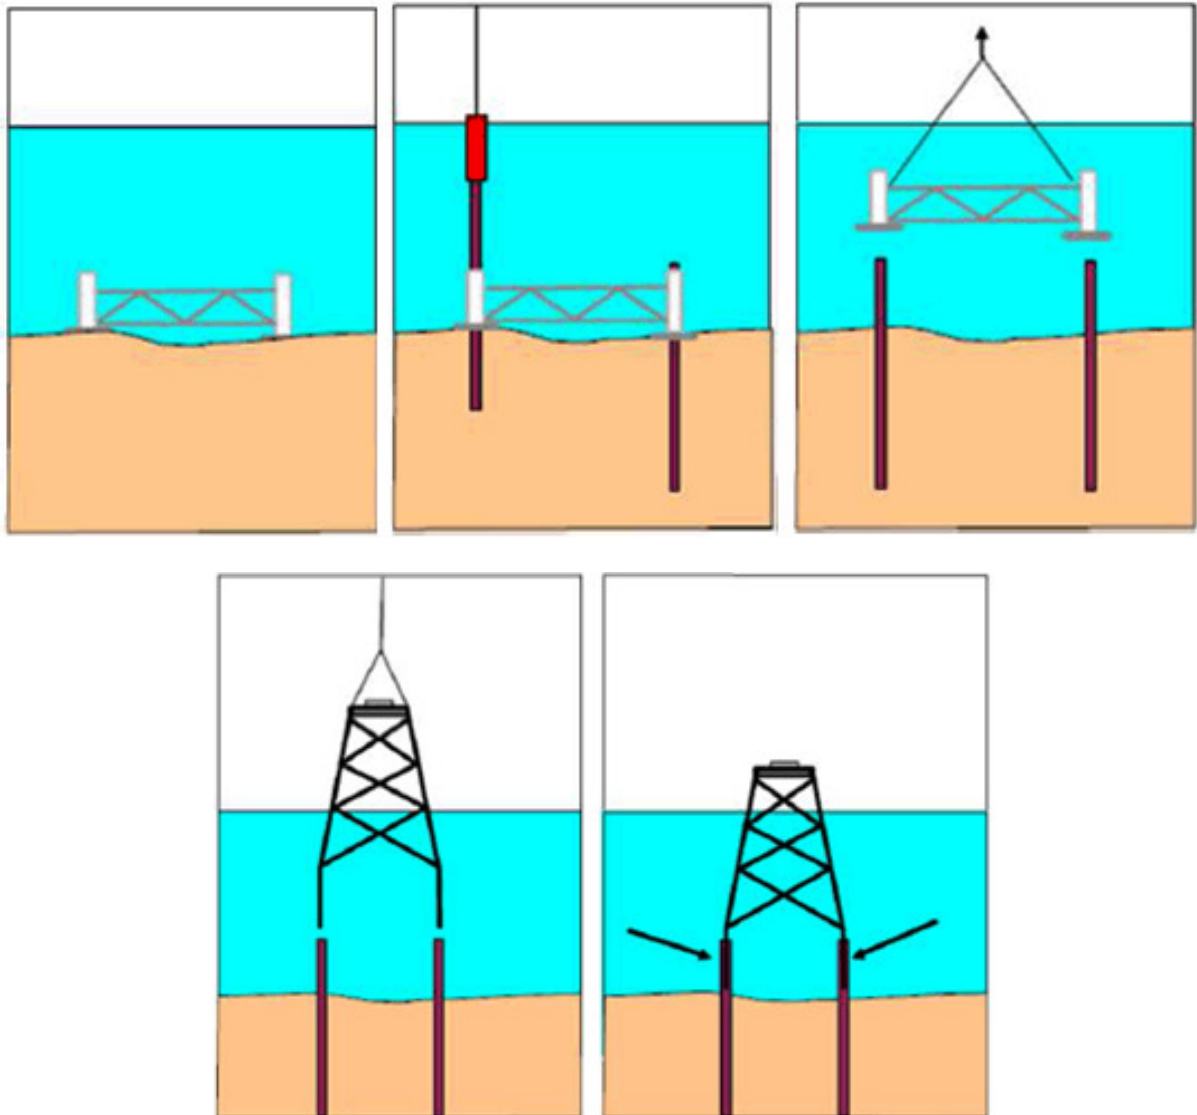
Installazione di jacket sui tubi fondari mediante meda ed intervento finale di grouting, come indicato dalle frecce
